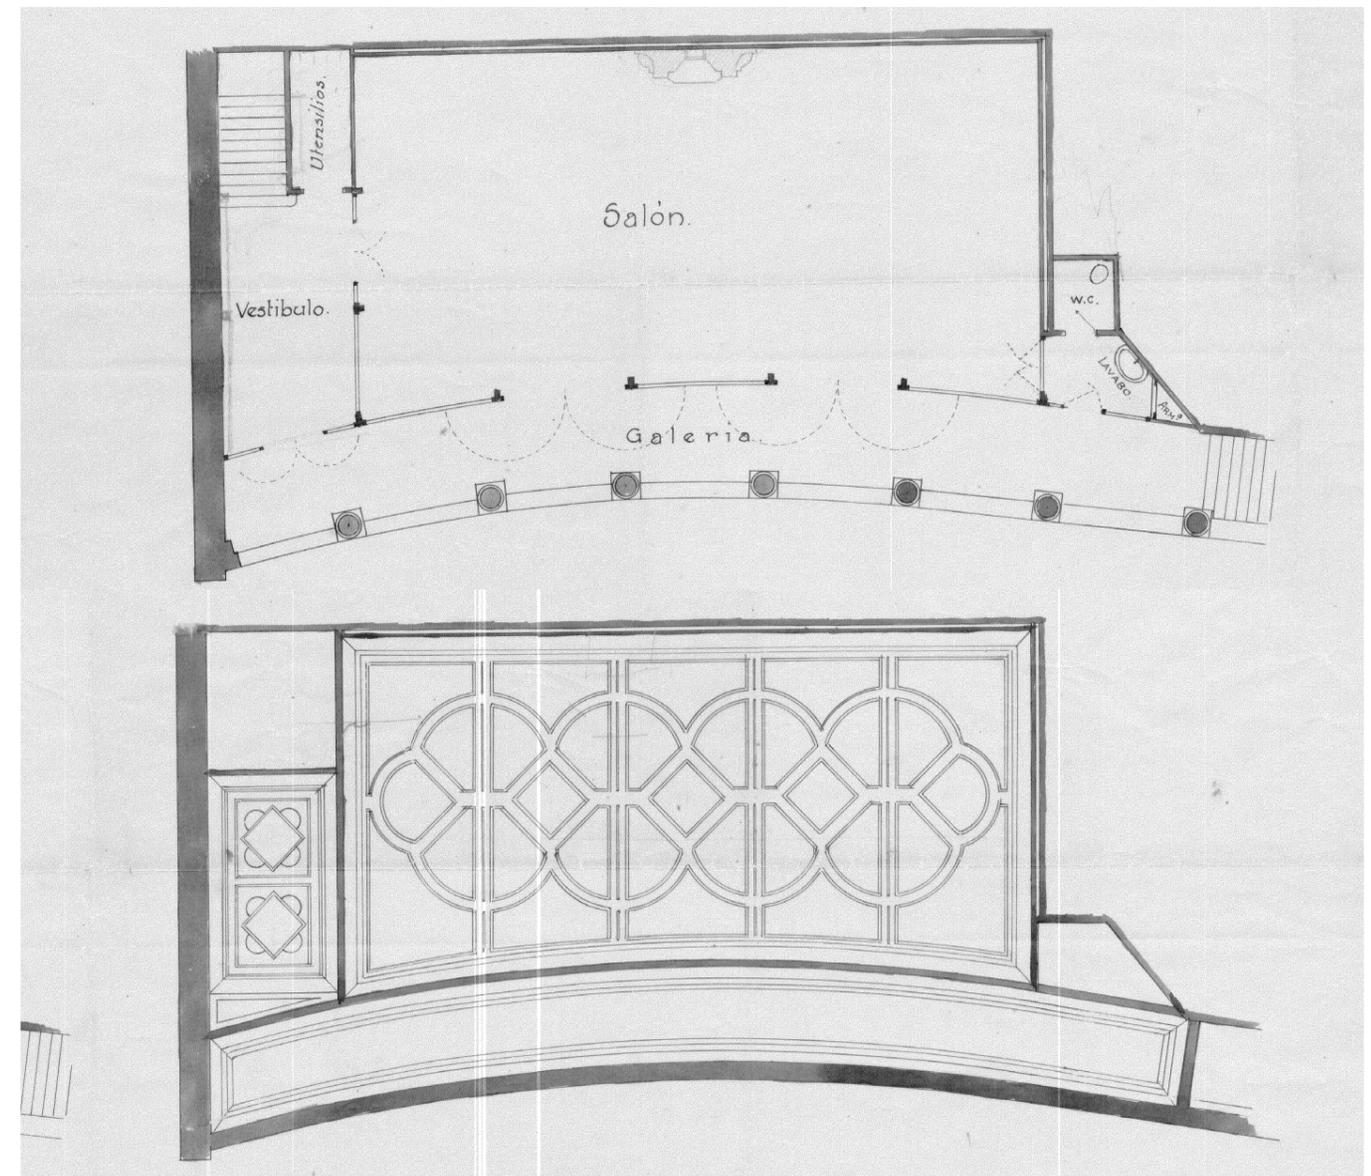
Detalle de planta y techo del salón de las galrías, Archivo municipal del ayuntamiento de Getxo.
